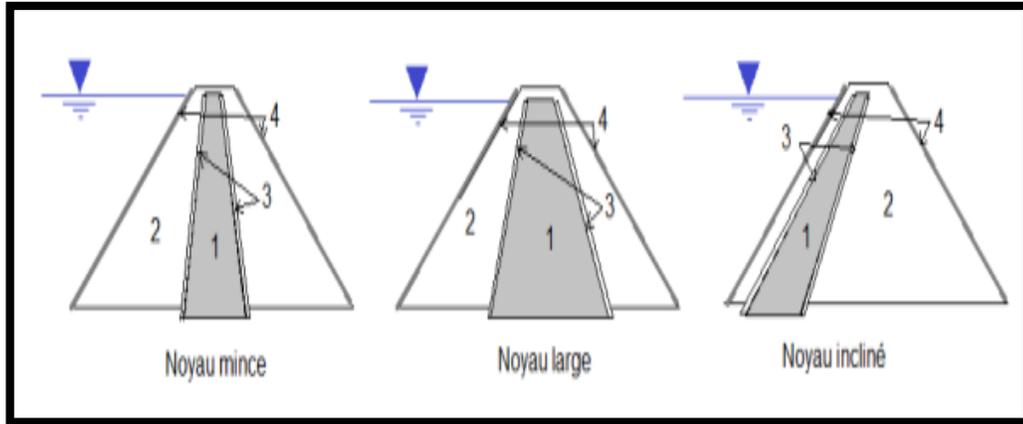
coupe d'un barrage en terre noyau étanche (Assemblée nationale)
